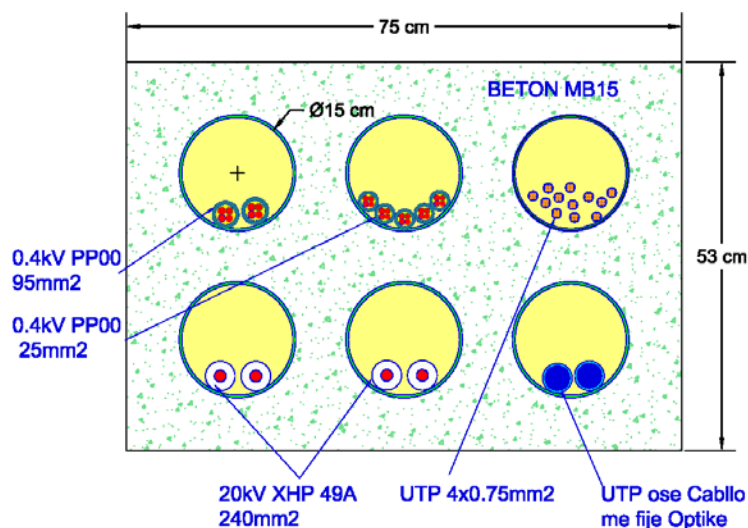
Kanalizimi kablovik me 6 gypa PVC në beton
